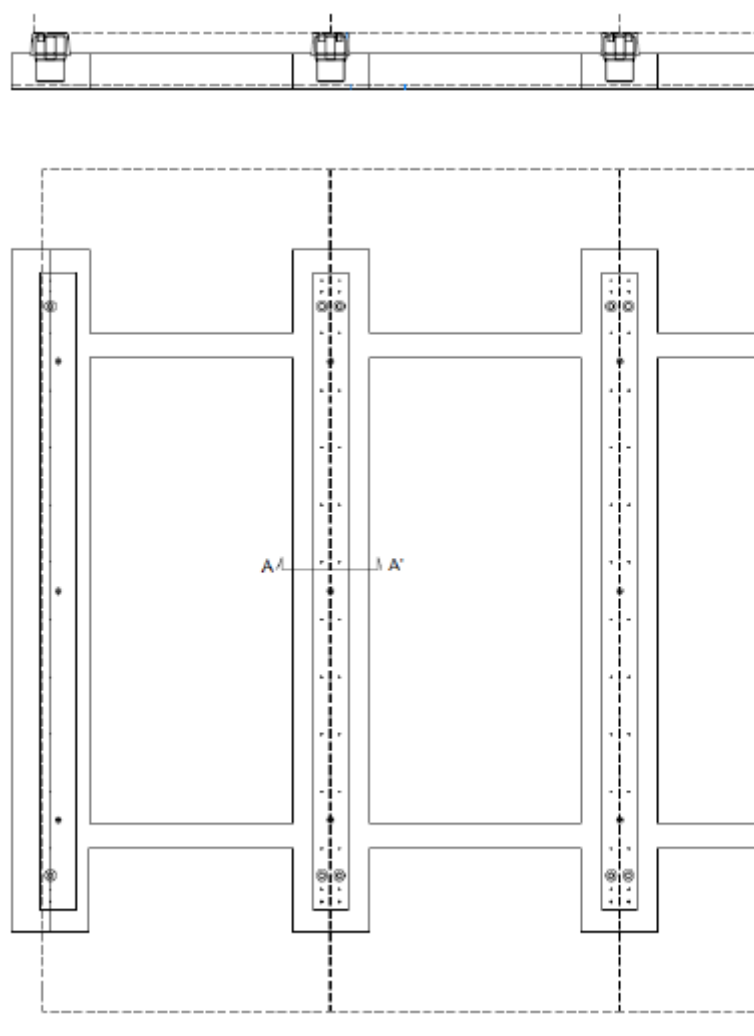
Vistas generales de la cimentación del edificio basada en vigas de cimentación Compact Habit®.
